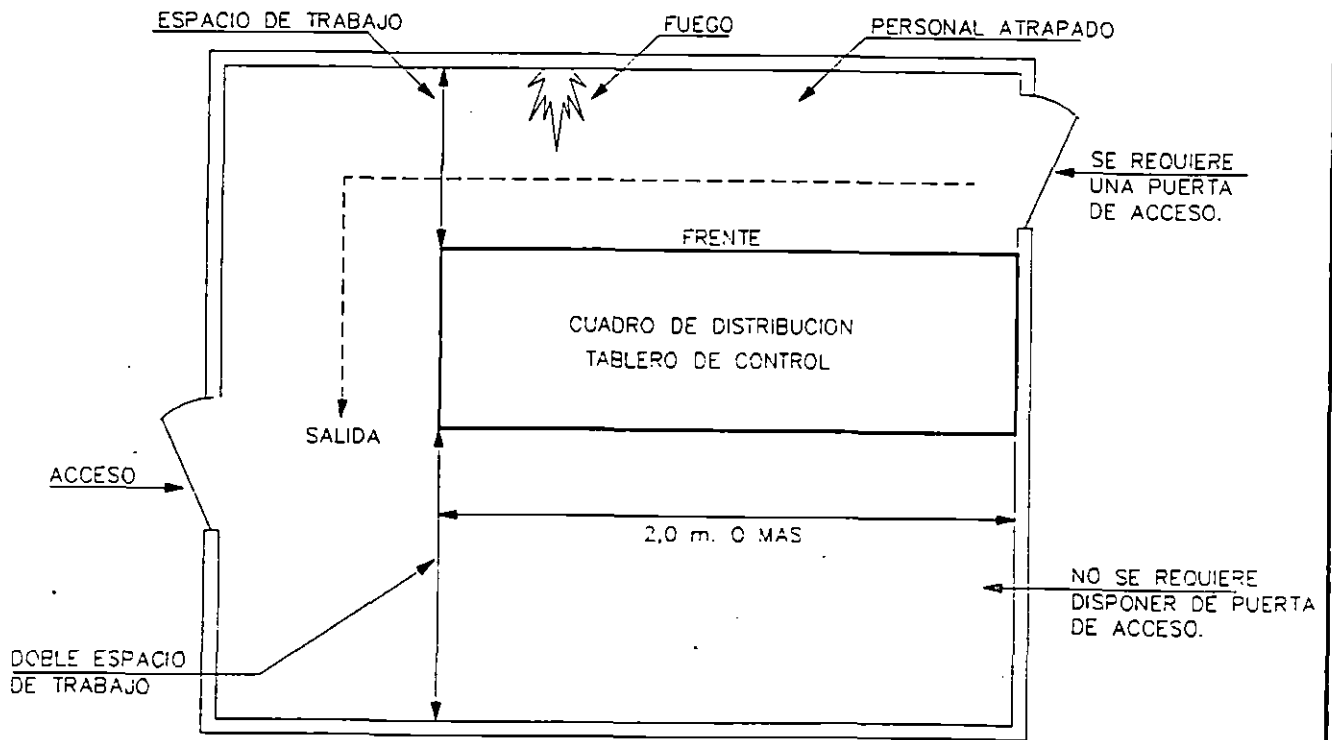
Caso en donde se requiere otra puerta de acceso.
